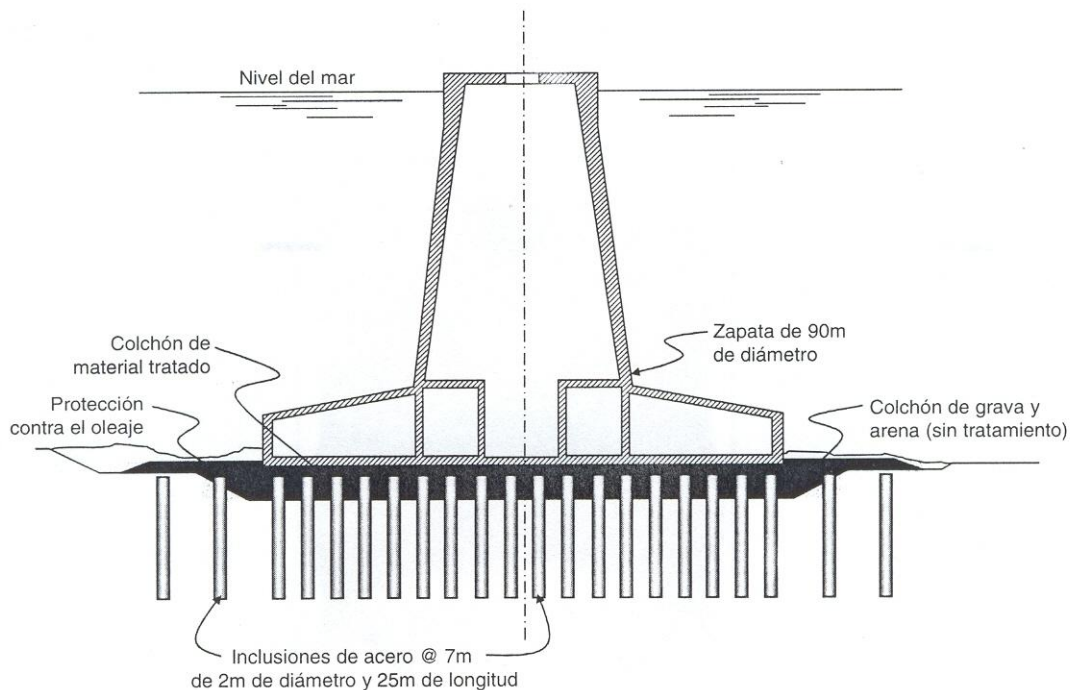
Inclusiones de Acero en el suelo de cimentación de una zapata
